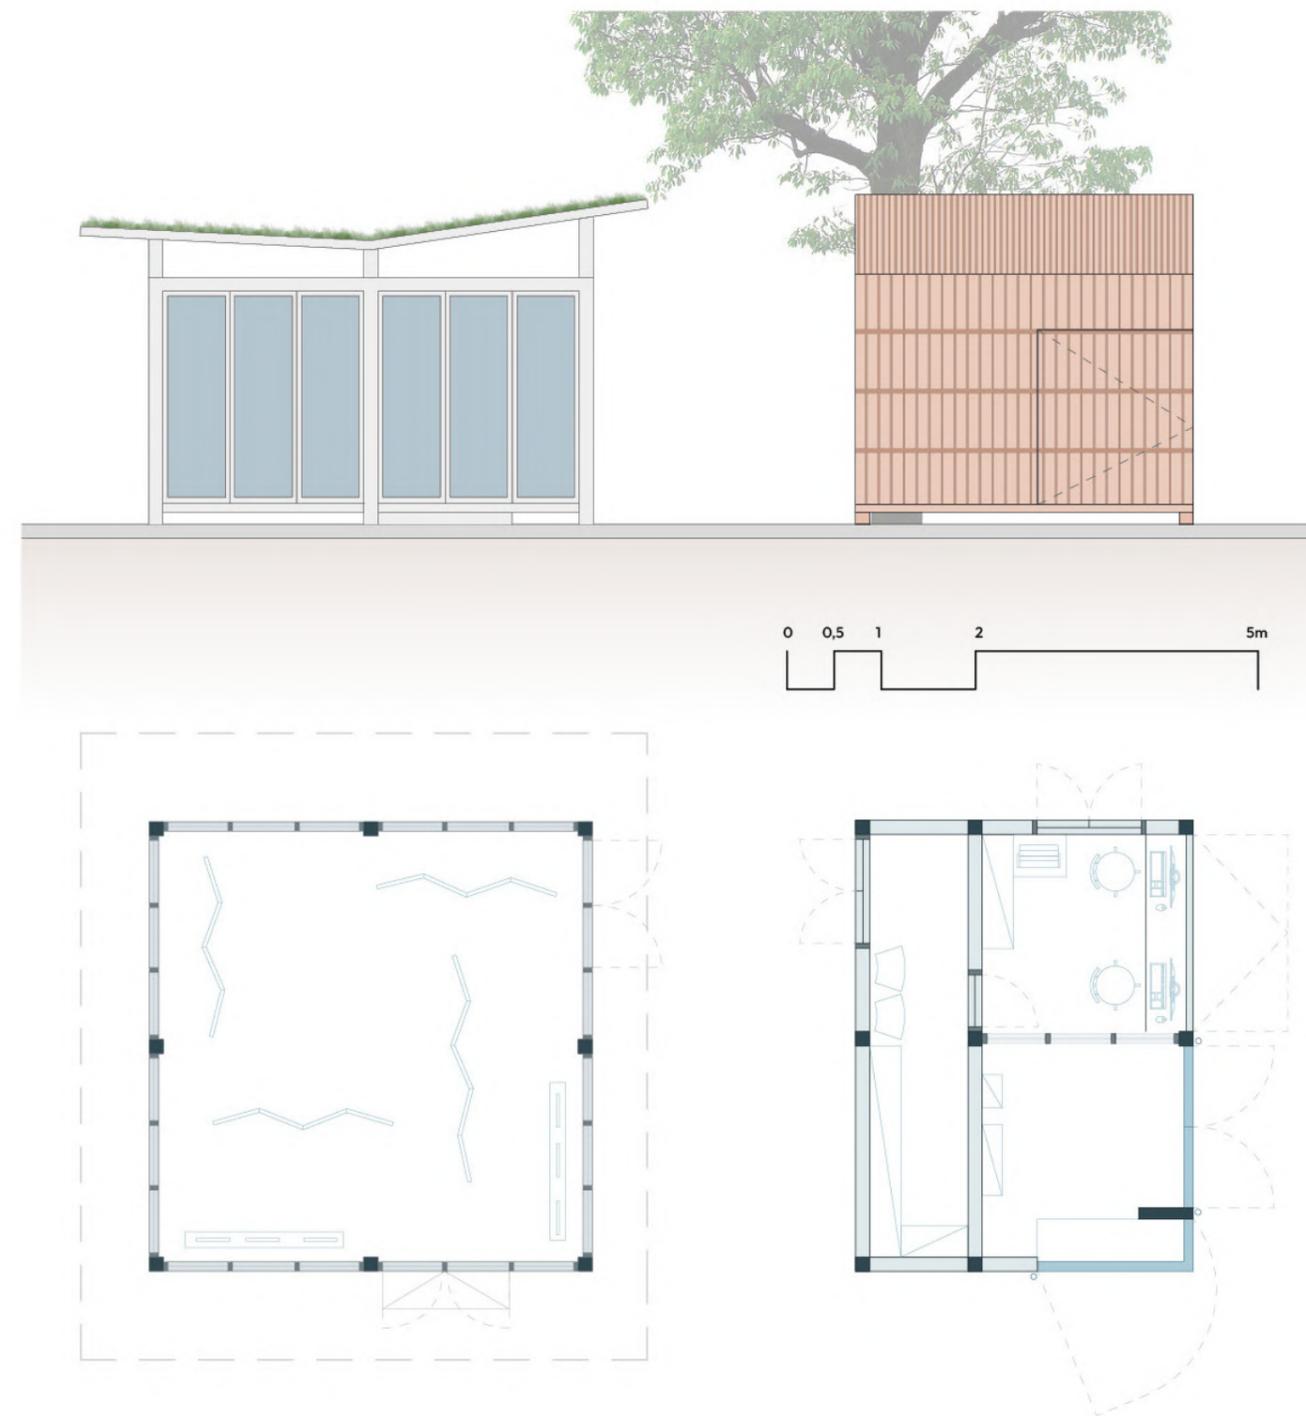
Prospetto e pianta del nuovo edificio della Portineria di Comunità ▲
